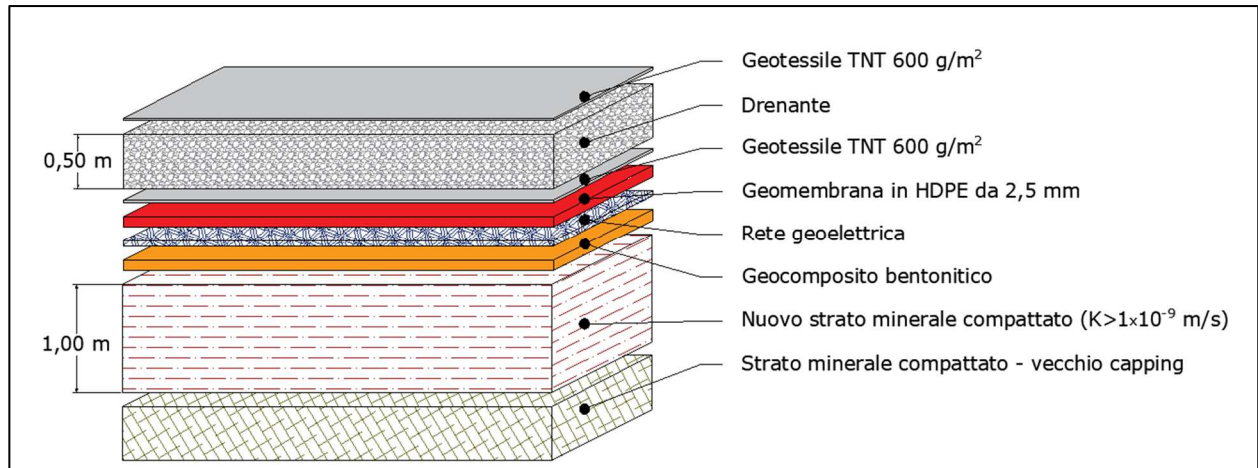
/XXI: Pacchetto impermeabilizzazione con sistema drenante - Caso b)
